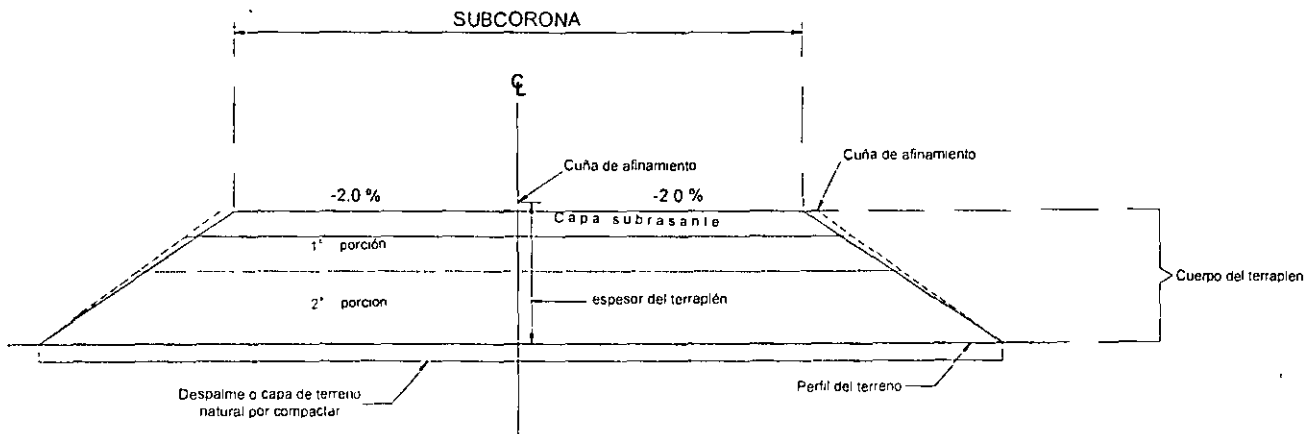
SECCION DE CONSTRUCCIÓN DE UN TERRAPLÉN EN TANGENTE
